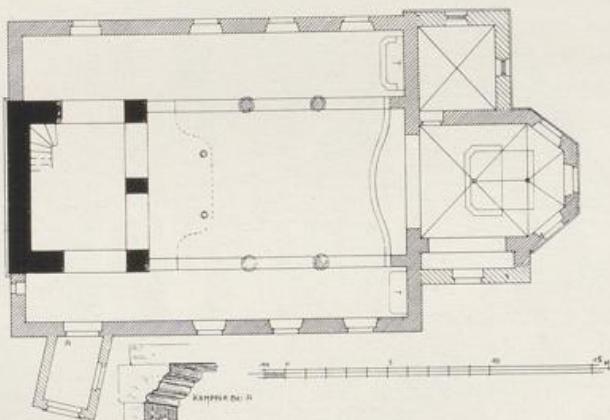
Merzenich. Grundriss der alten kathol. Pfarrkirche.
